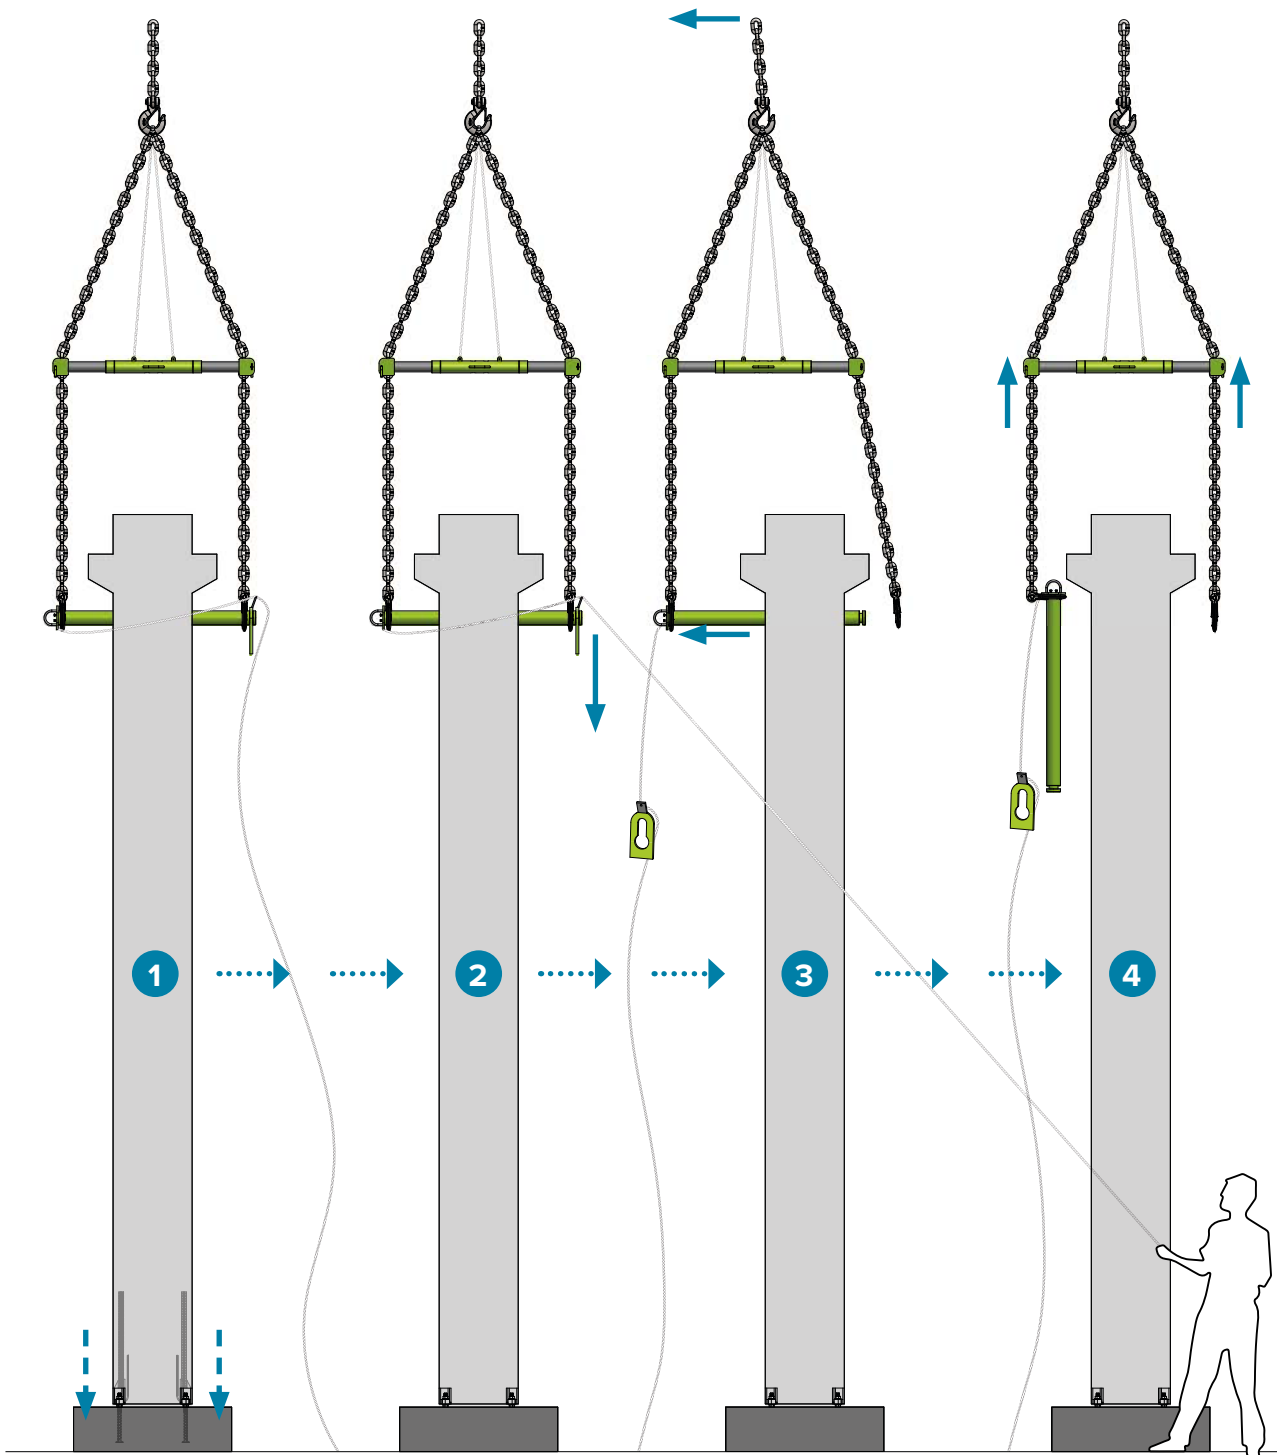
Rimozione del Sistema di Montaggio COLIFT dall'elemento prefabbricato.
